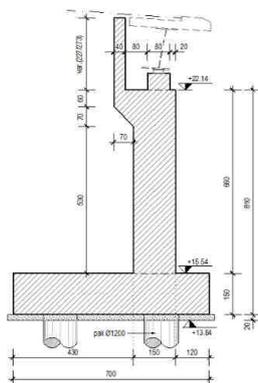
Sezione trasversale ortogonale alle travi principali Sottovia svincolo SS.125 – rampa 5
